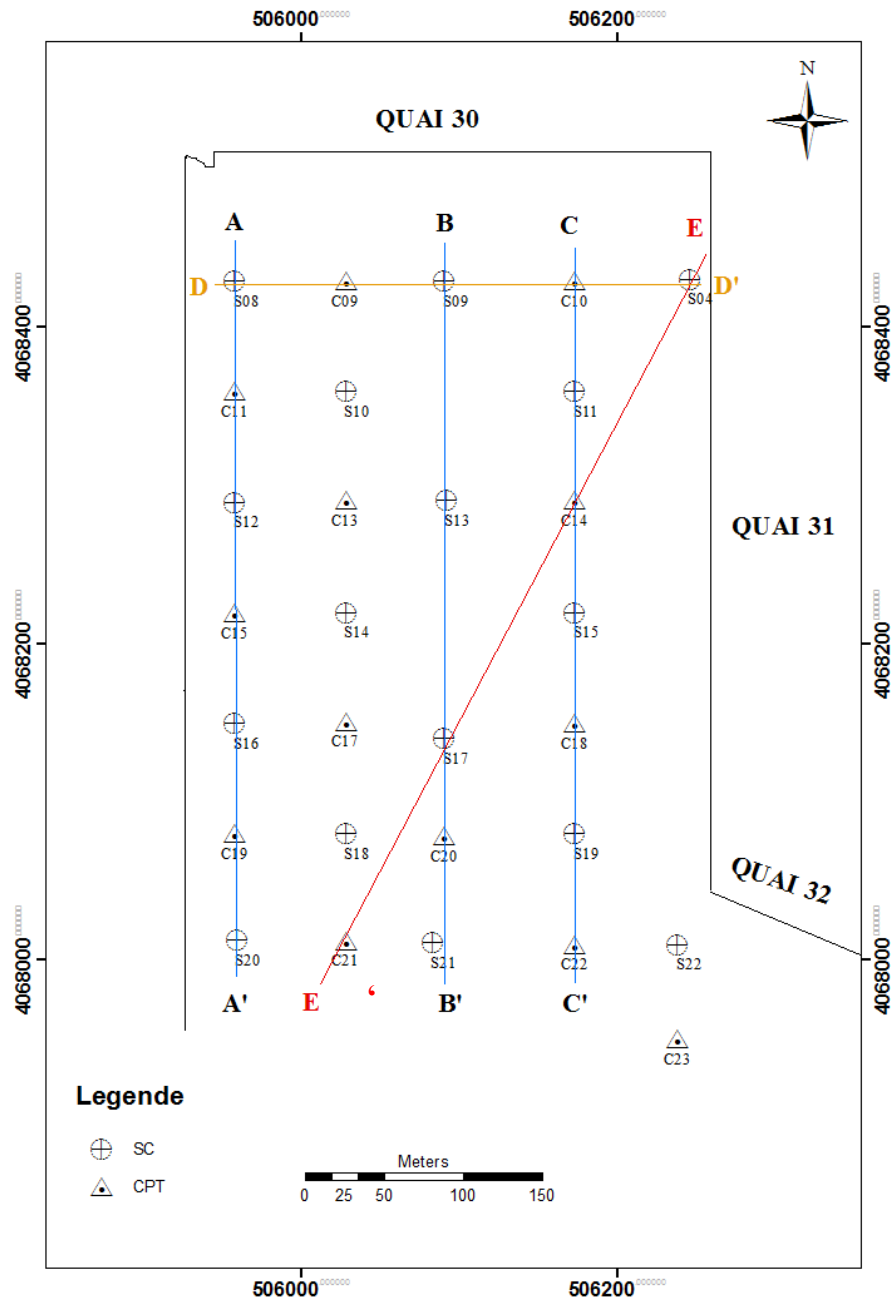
Plan d'implantation des essais in-situ et sondage carotté
